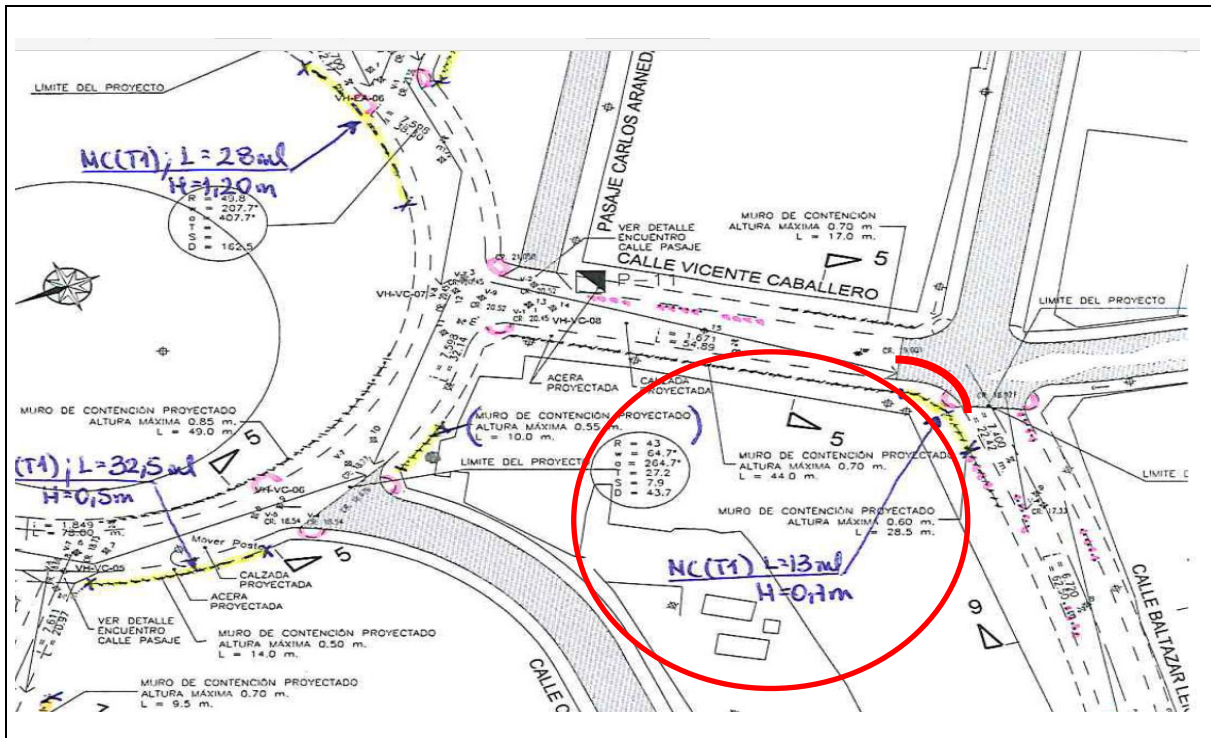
Detalle de muro hormigón armado G30,  $0,4m < h < 1,2m$ ", de longitud de 13 m y de altura de 0,70 m según plano modificado en terreno.
